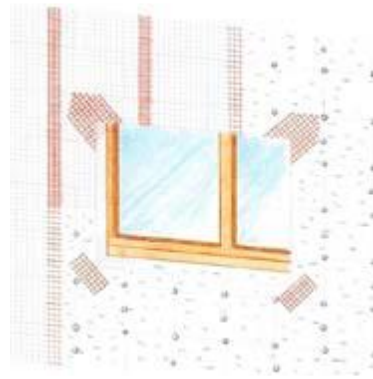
Detalle de aplicación de malla de armadura en el ángulo de esquinas de ventanas y puertas
